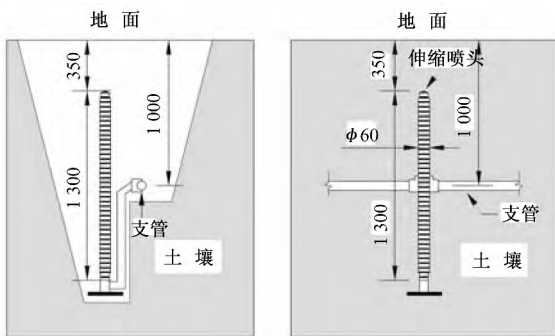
自升人降型安装示意图(埋深 100 cm)(单位:mm)
